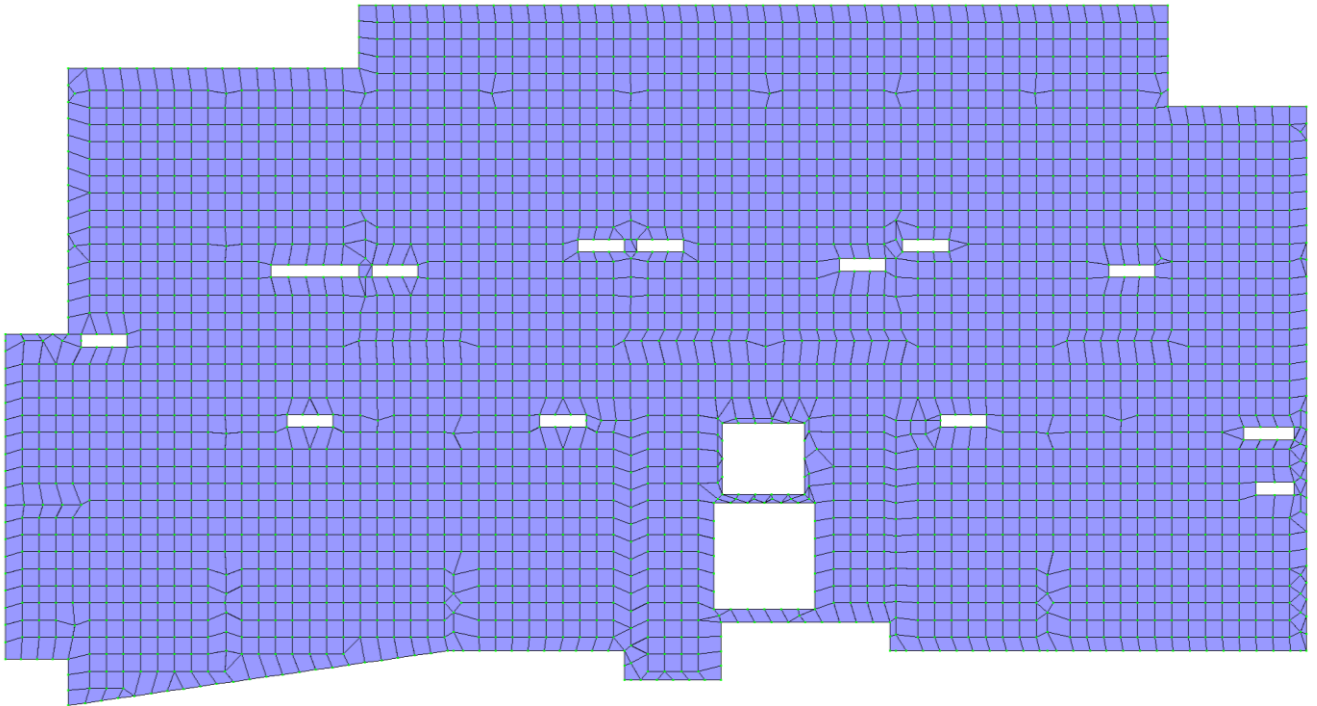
Розрахункова схема плити перекриття на відмітці + 0,000
